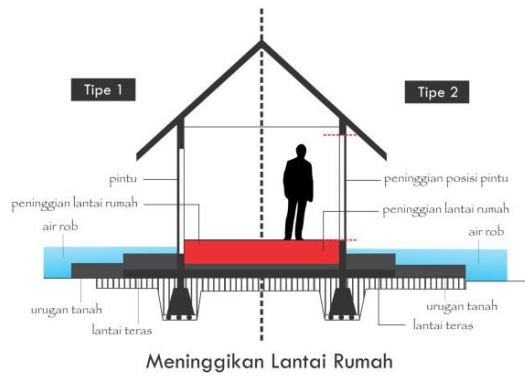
a. peninggian lantai teras Tipe 1, b. peninggian lantai teras Tipe 2
